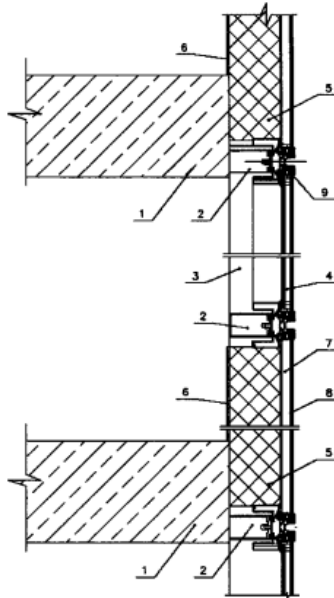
Конструктивна схема збірної системи з комбінованим світлопрозорим фасадом: 1 – плита перекриття; 2 – елементи несучого каркаса (ригель); 3 – елементи несучого каркасу (стояки); 4 – склопакети (із сонцезахисним склом); 5 – утеплювач; 6 – внутрішня обшивка; 7 – вентиляційний повітряний прошарок; 8 – опоряджувальний світлопрозорий шар; 9 – елемент кріплення опоряджувального шару. Джерело – [5]
